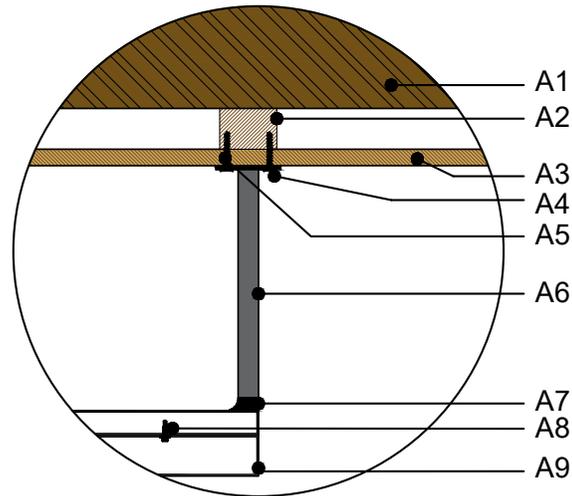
Detalle Constructivo 1 – Sujeción de Riel a Cielo Raso
